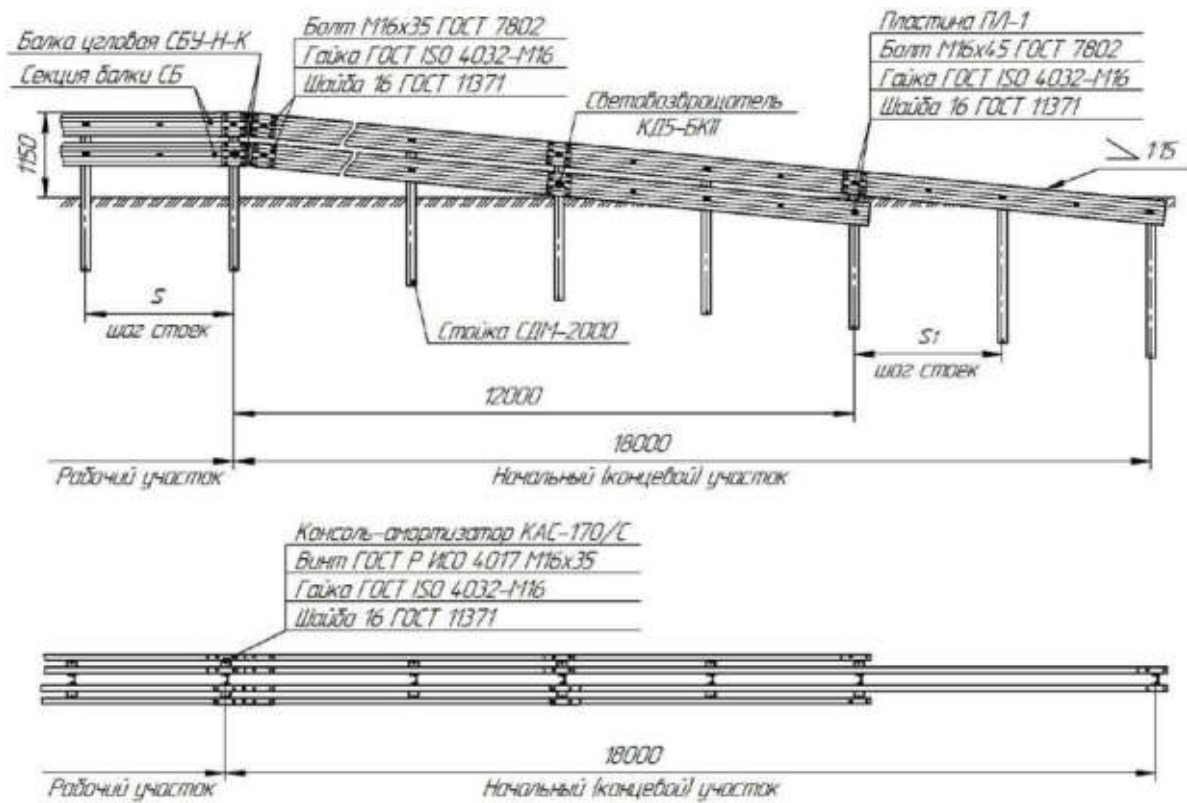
Схема сборки конструкции №12 (Изм. №1)
